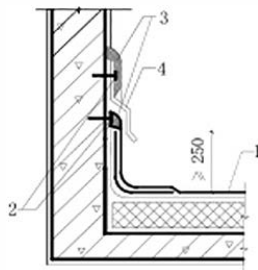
混凝土墙体泛水卷材张口、脱落渗漏维修
